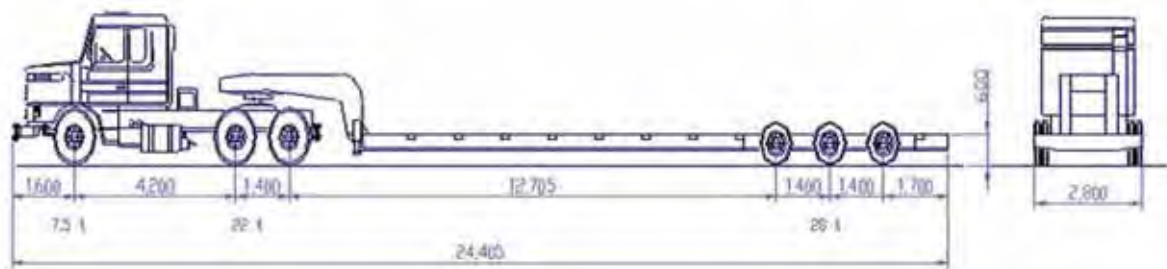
Semi-Reboque Articulado Plataforma Rebaixada tipo “Lagartixa”
